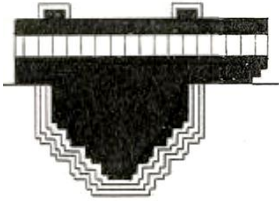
مسقط أفقي لقاعدة منذنة دادا
